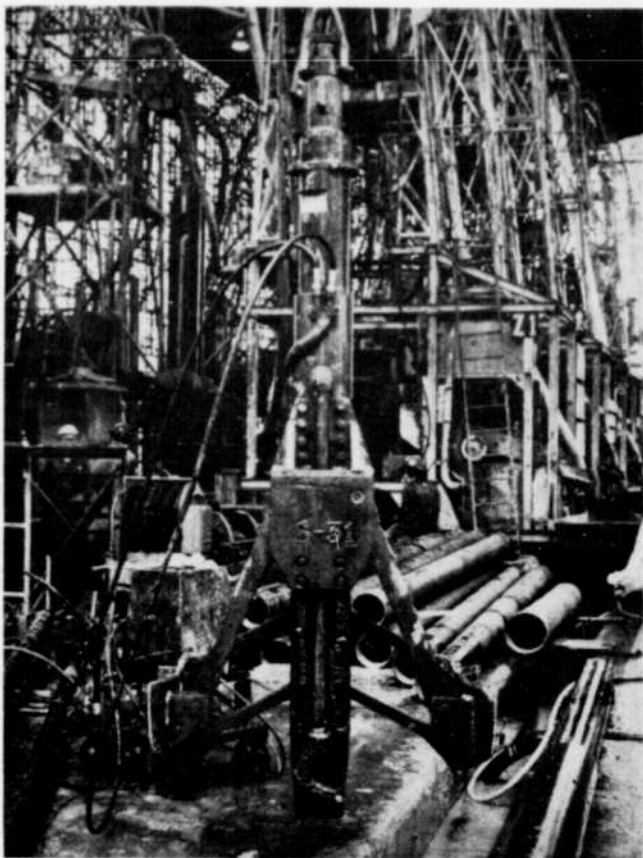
Trépan biconcave pour l'excavation des pieux secondaires.
